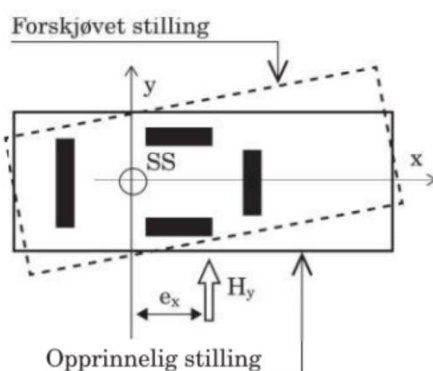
Illustrasjon av stivhetssenter ((Betongelementforeningen, 2016), fig. B.12.11, s.105)
